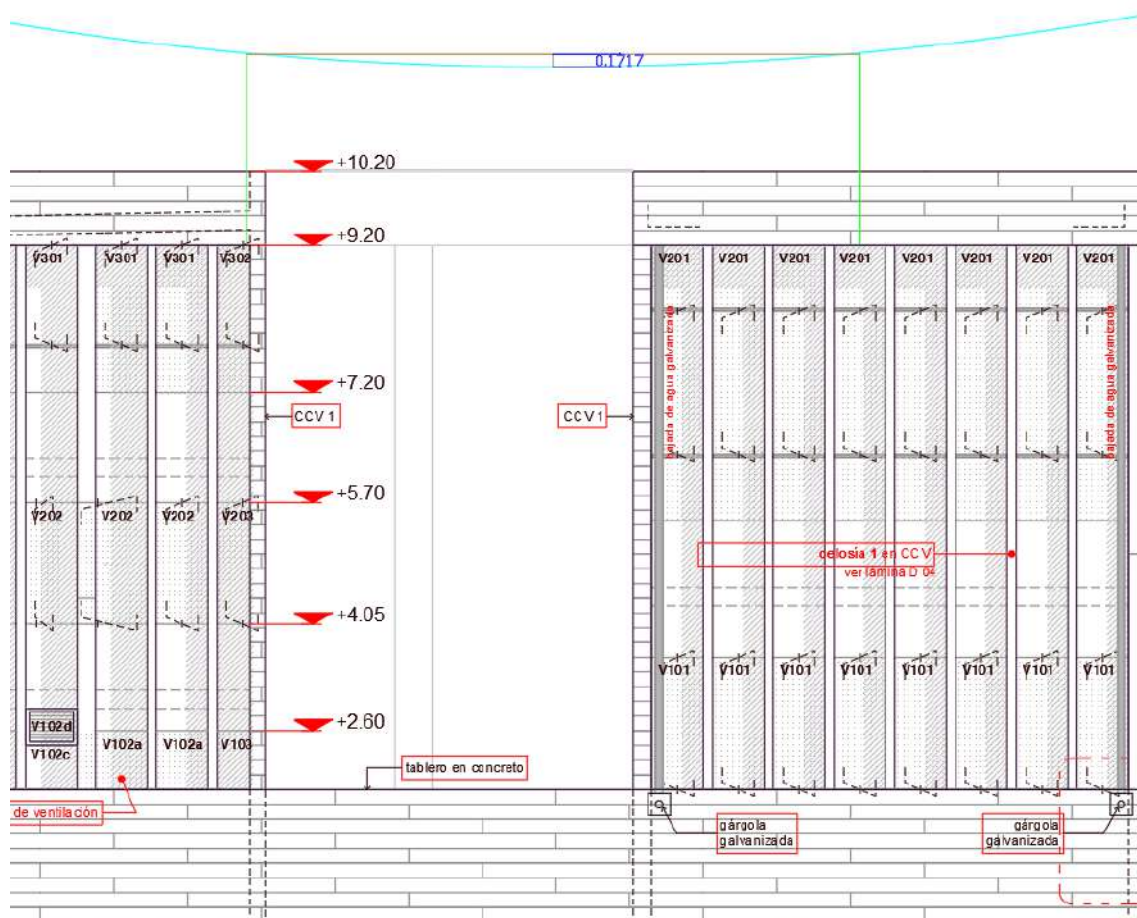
Vista de elevación con la separación dada por el ítem 3.
